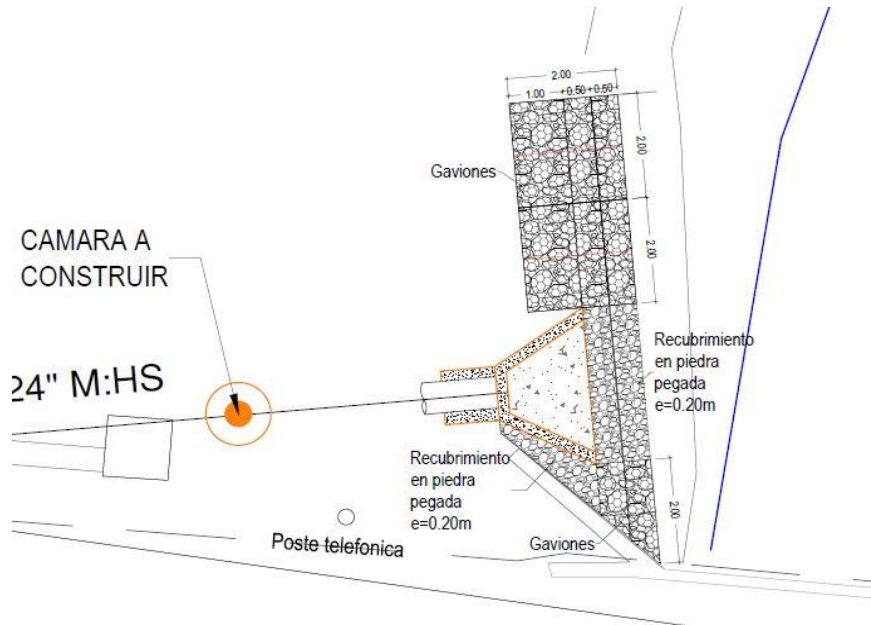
Detalle de las obras del cabezal de descarga, vista en planta.
